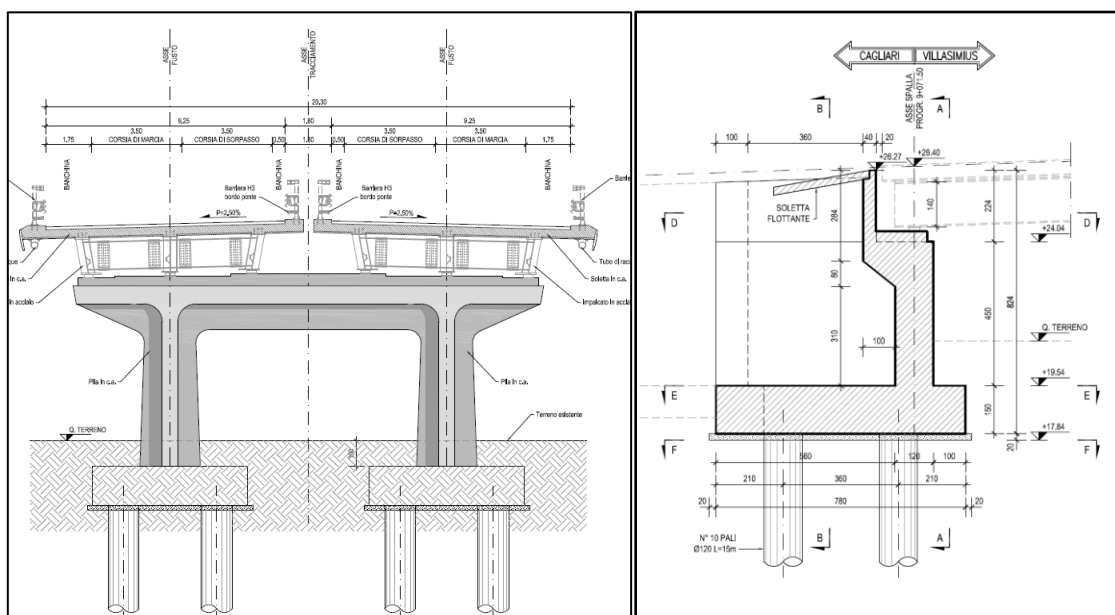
Vista frontale della pila tipo e sezione longitudinale della spalla SP1
